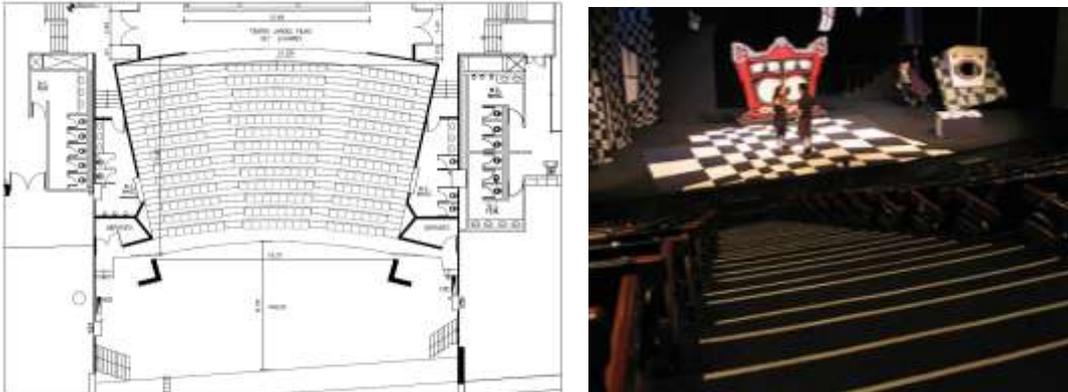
e 52: Planta e foto da Sala Adoniran Barbosa (respectivamente)
